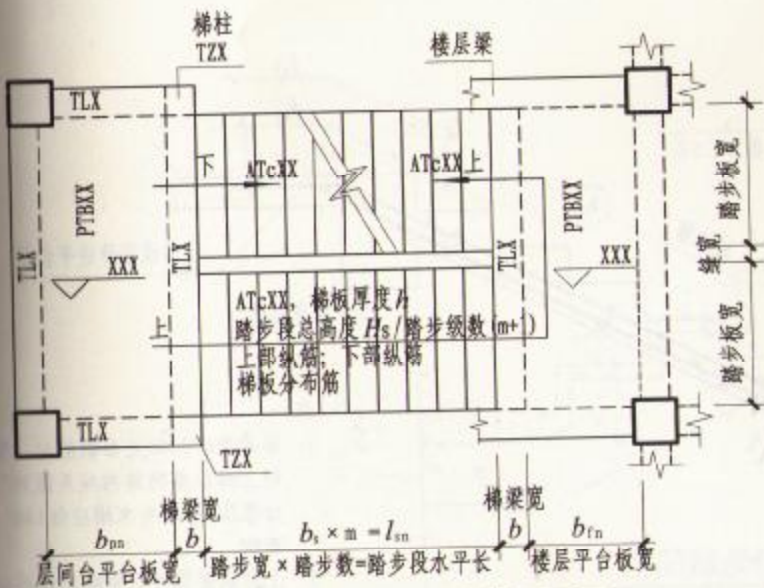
注写方式 标高XXX—标高XXX楼梯平面图
